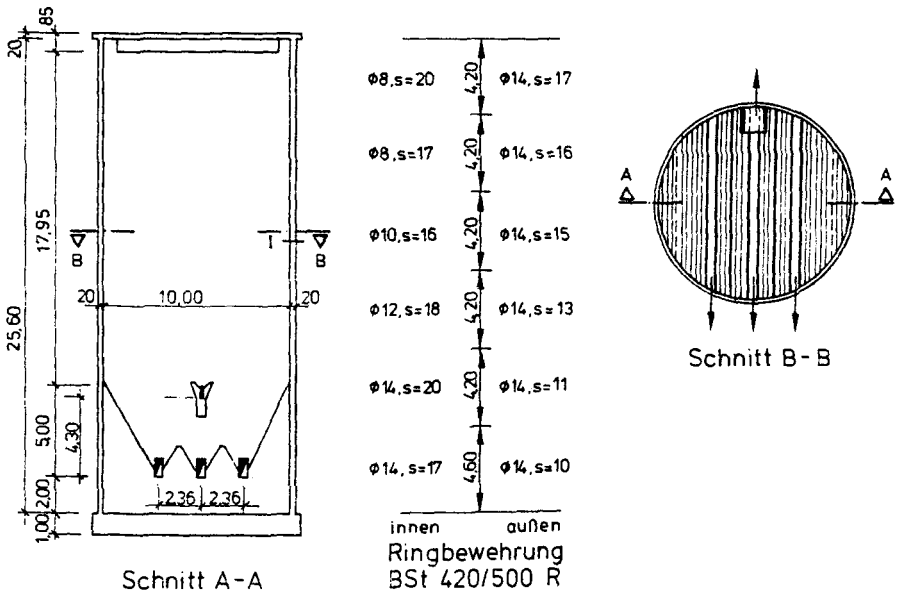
Schnitte und planmäßige Ringbewehrung
